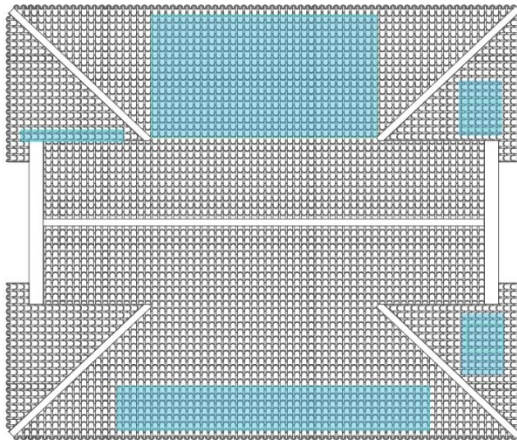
Plano de cubierta con las zonas de filtraciones marcadas.
